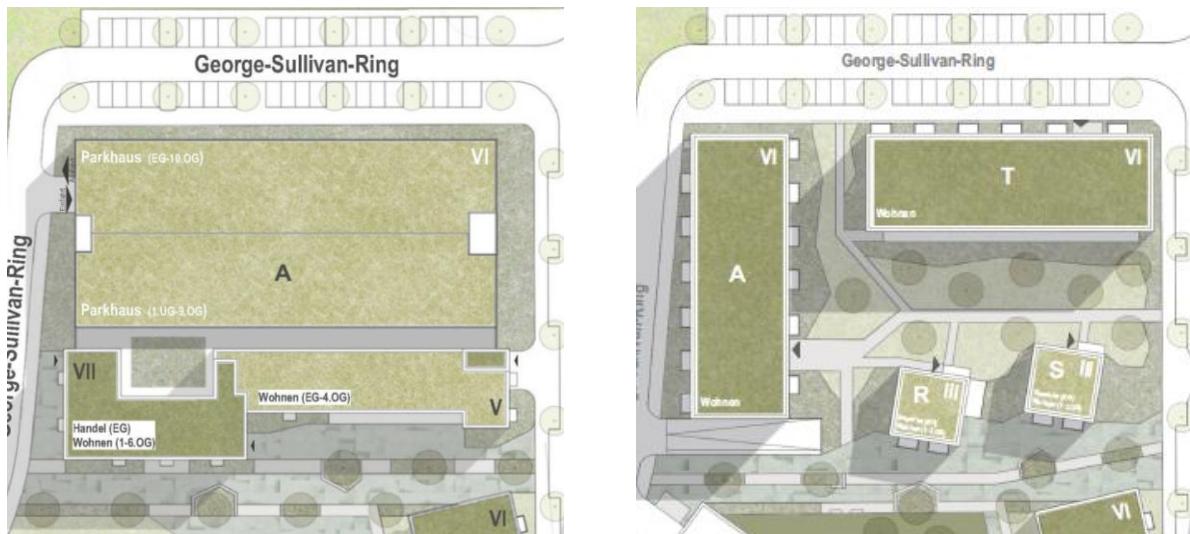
Detail der nordwestlichen Ecke des Plangebiets mit Anzahl der Vollgeschosse (links Planung Mai 2025 /1/, rechts aktuelle Planung /2/)
